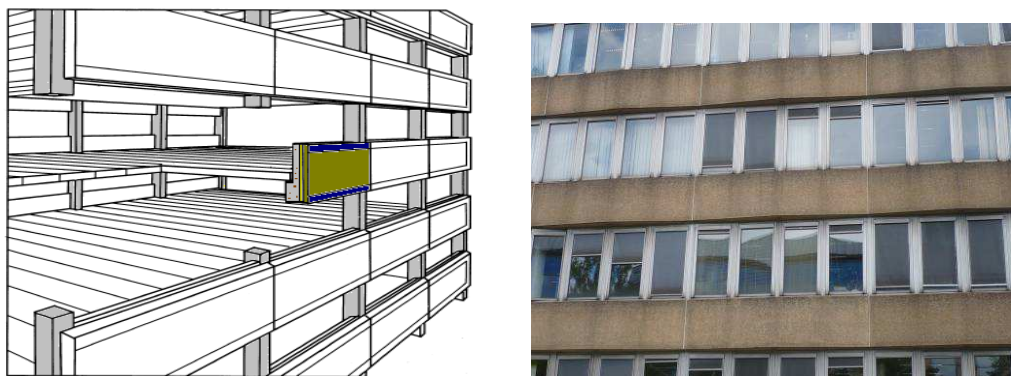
Verticale doorsnede in een gevel uit zelfdragende sandwichpanelen
